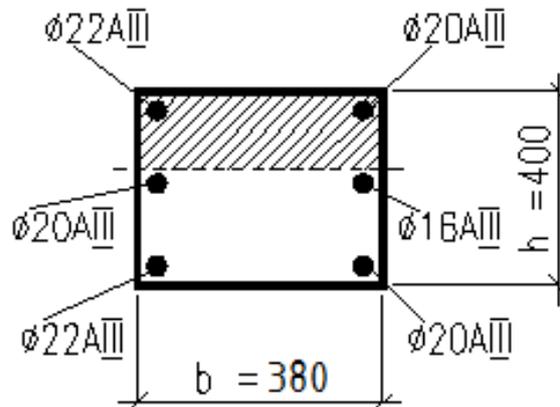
Схема перерізу надкранової частини при розрахунку із площини згину
